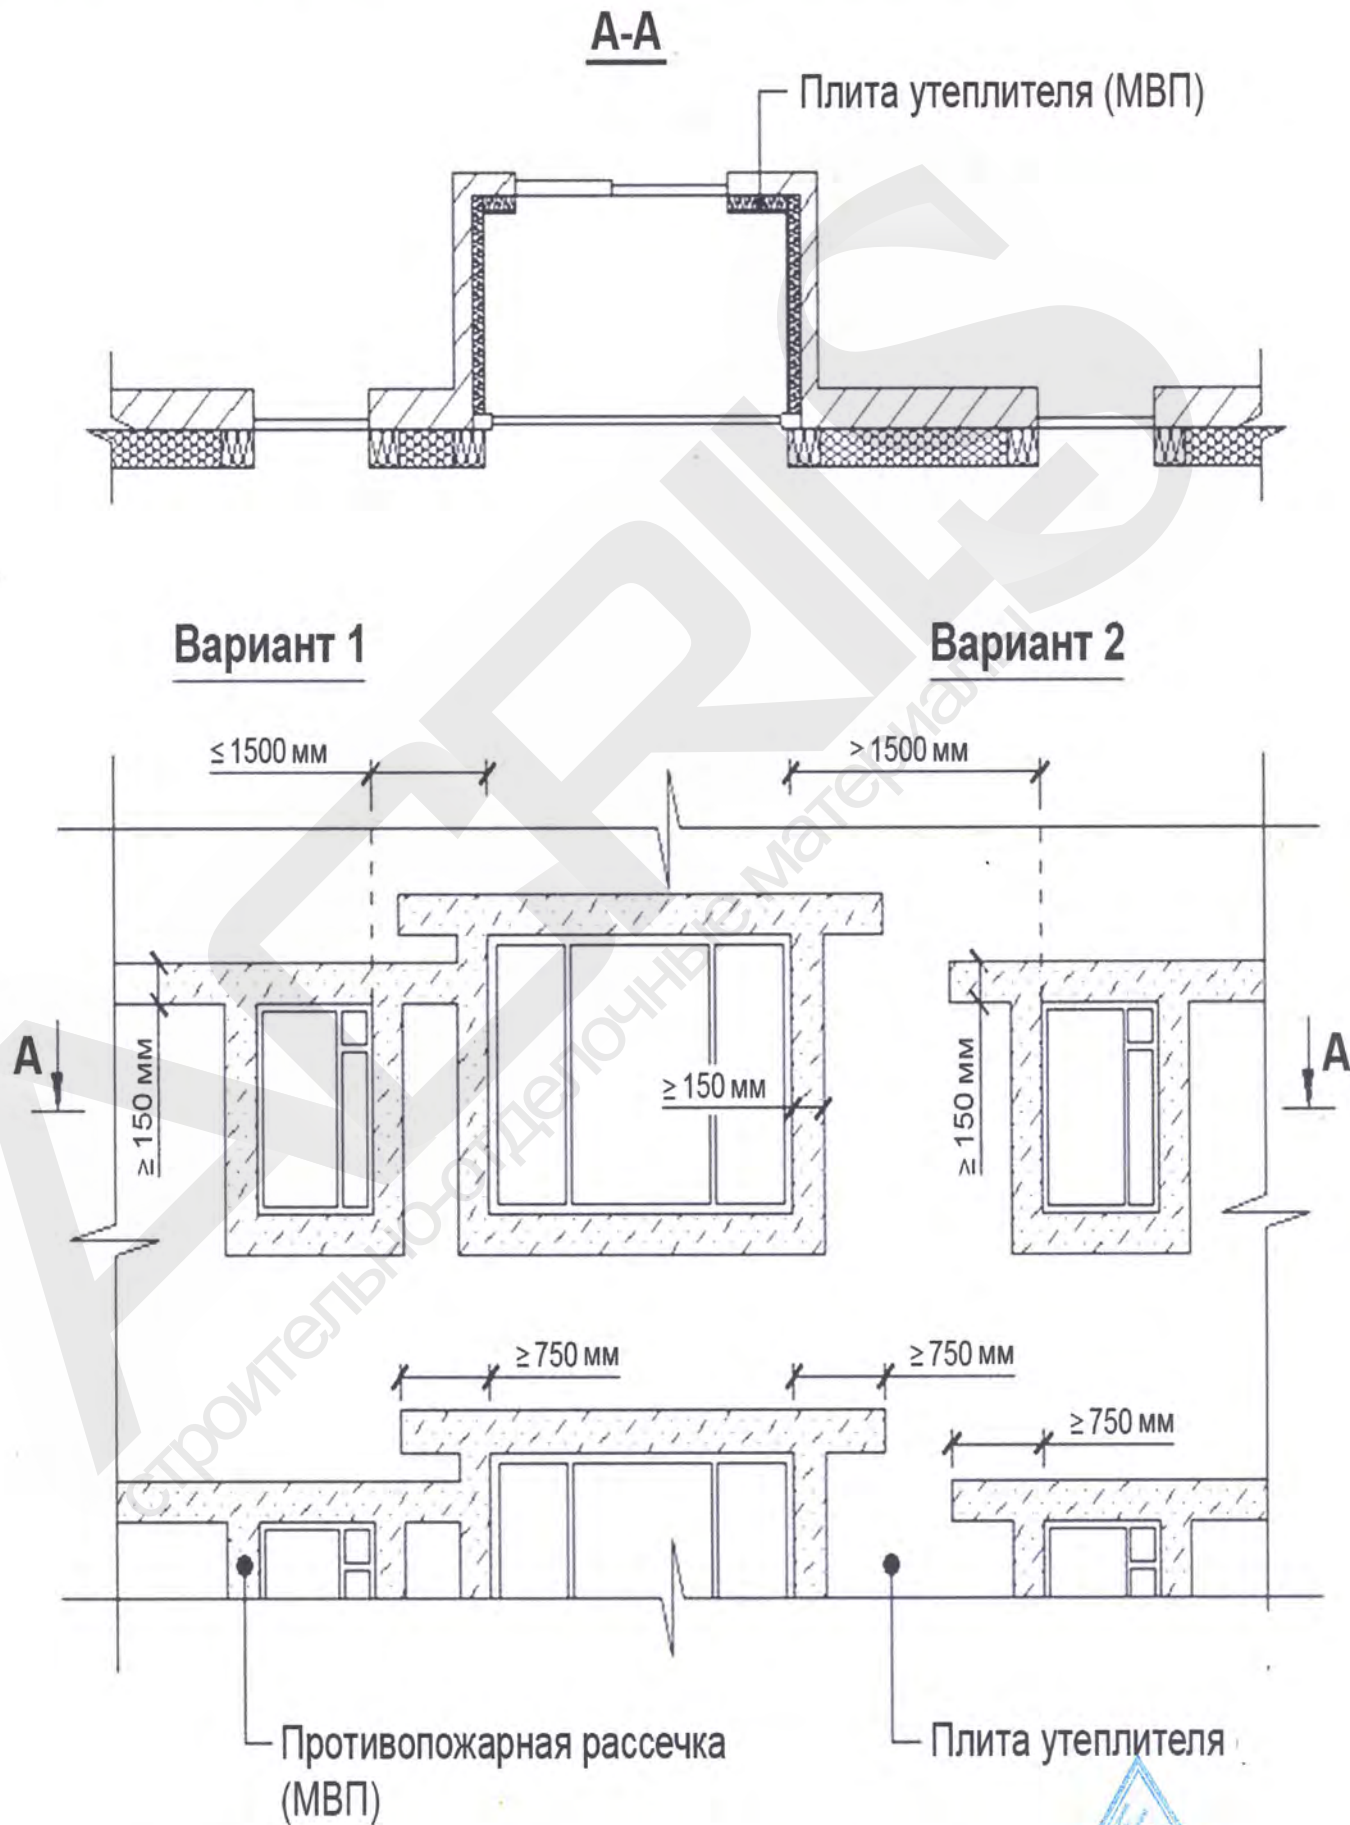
Участки наружных стен по периметру остекленных лоджий
